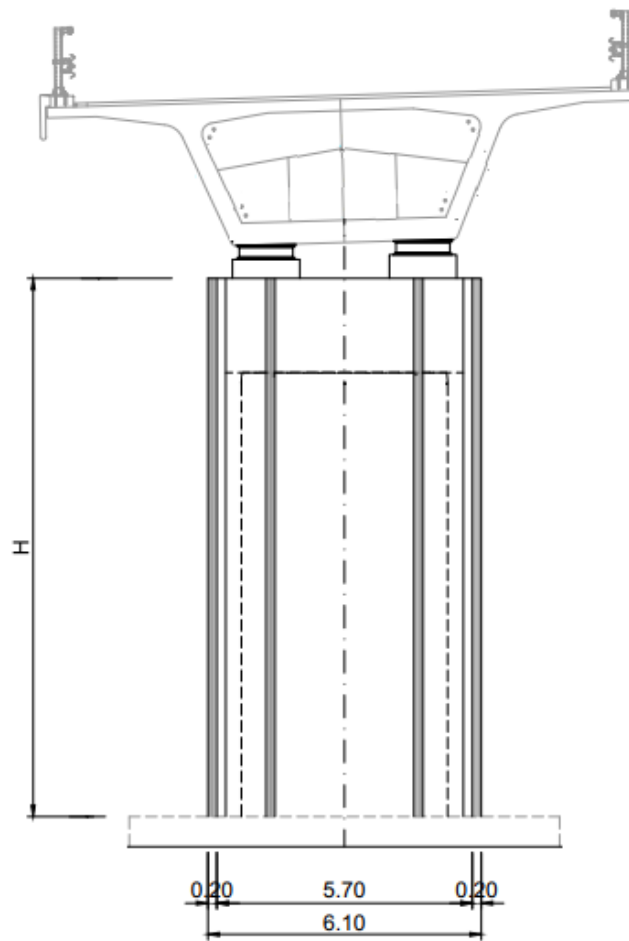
Elévation de la pile dans le sens transversal du pont.
